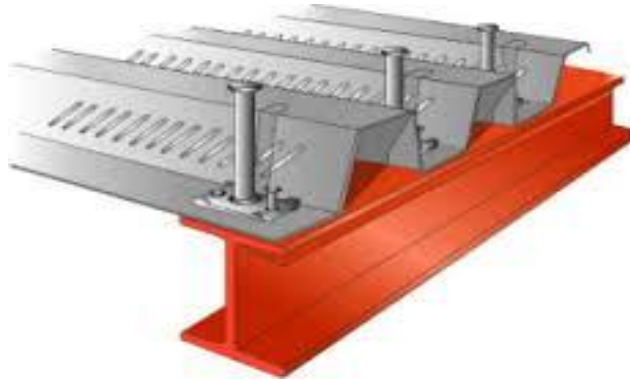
Goujons à tête soudée avec la dalle mixte
